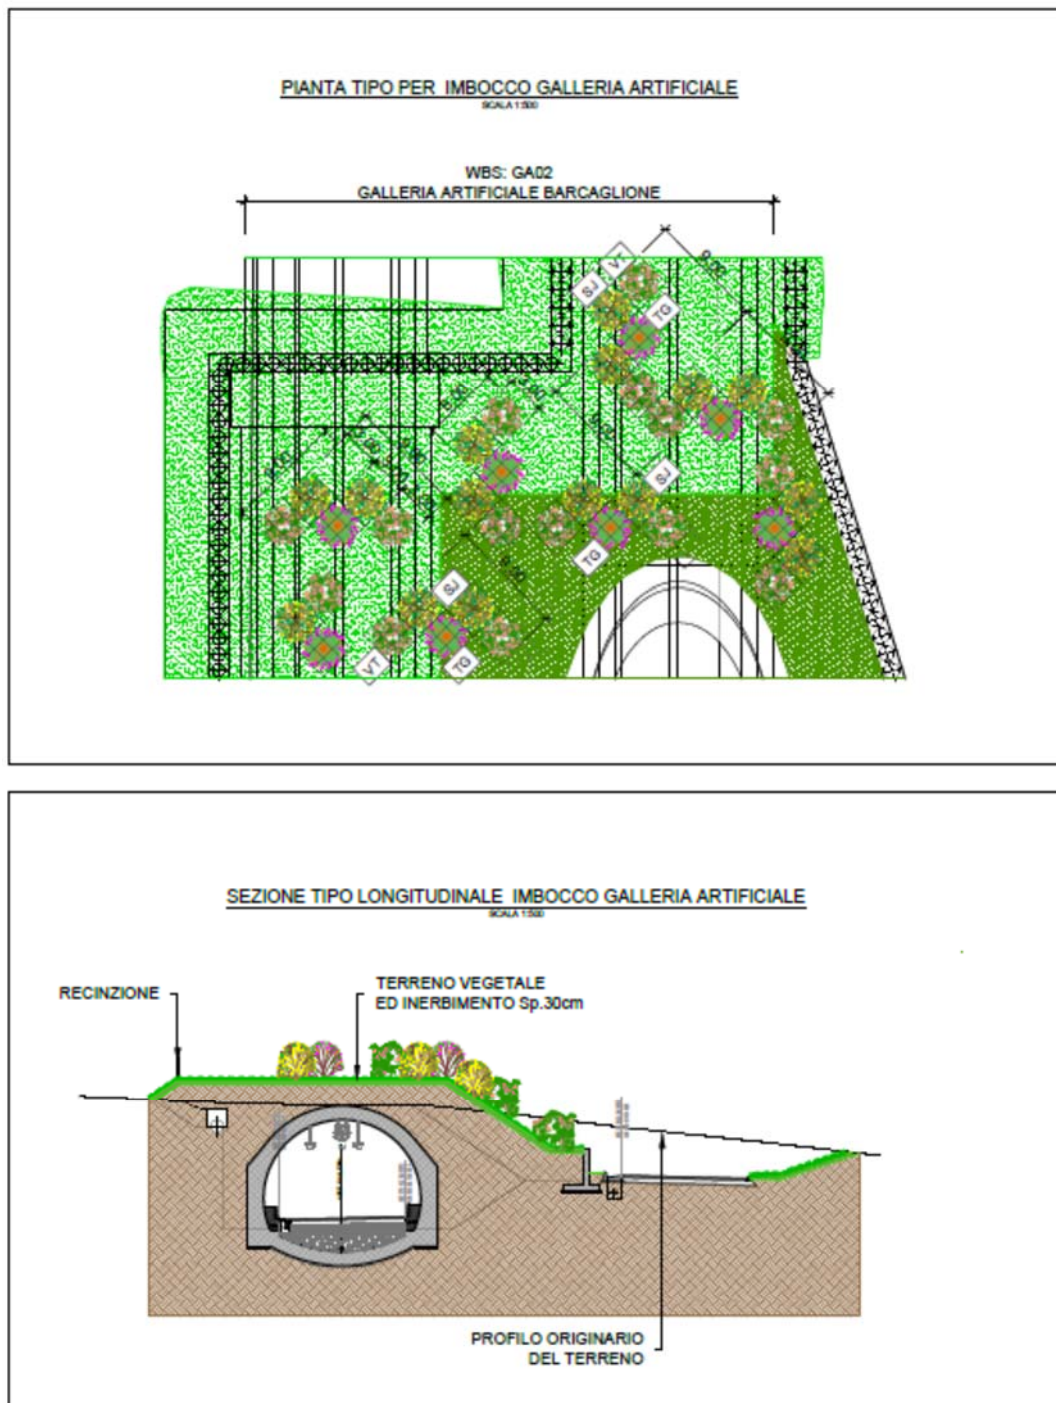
Sezione e planimetria tipo per imbocchi galleria artificiale
